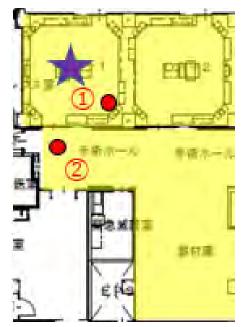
基地局配置図 (脳神経内科 (処置室))
